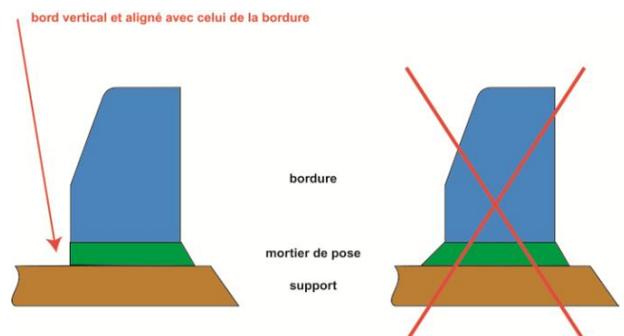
Le mortier de pose ou le support de la bordure coulé en place est éventuellement retillé à la verticale de la bordure et n'empiète pas sur la dalle en réduisant localement l'épaisseur
